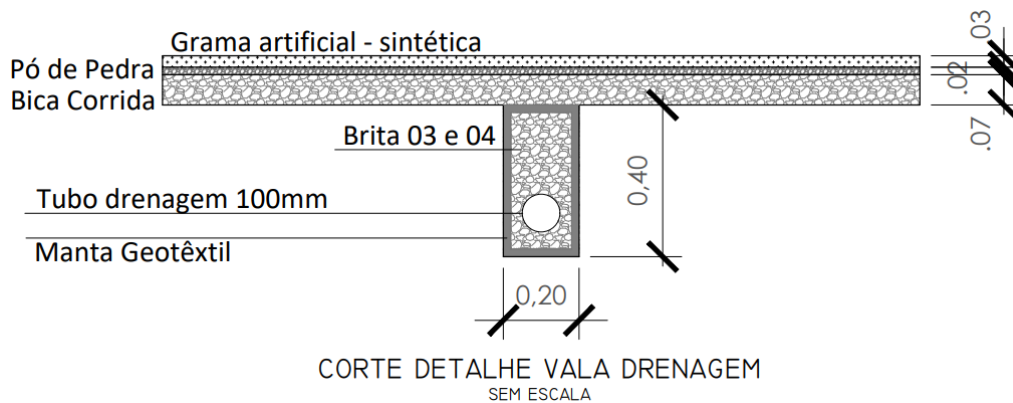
Detalhe de instalação Drenagem (Fonte: Autora/2021)
